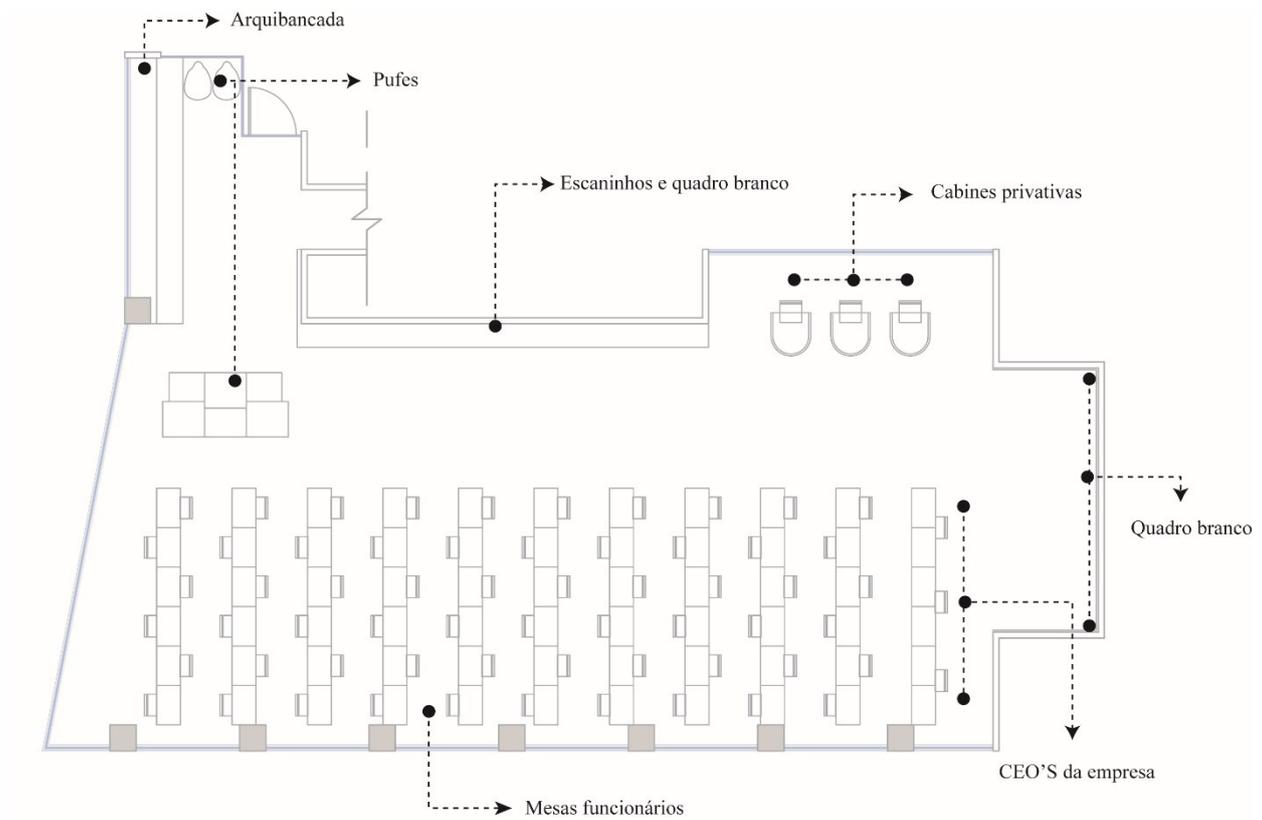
Primeiro pavimento da Allugator (Produção do autor)
